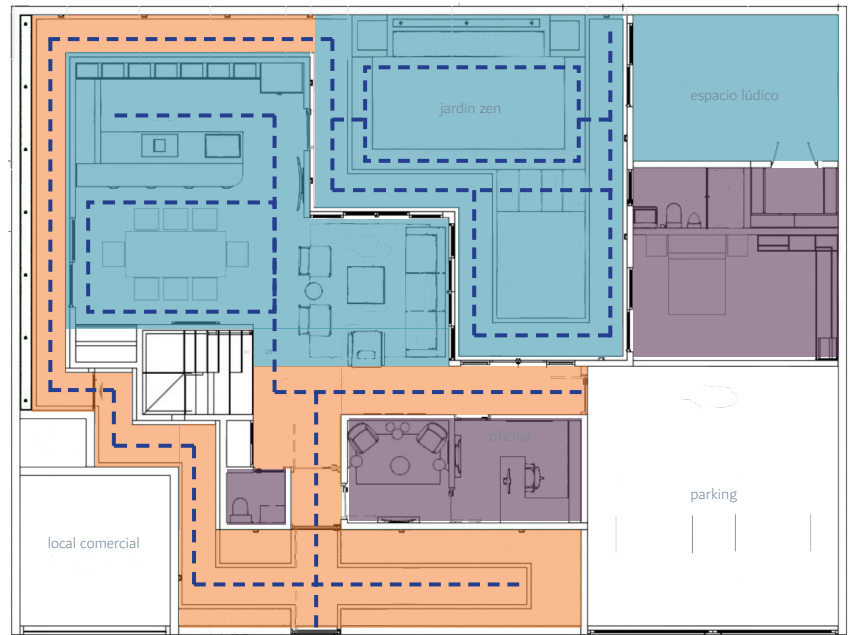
Casa Roble 23. Planta baja. (Fuente: Gimetric Arquitectos)
